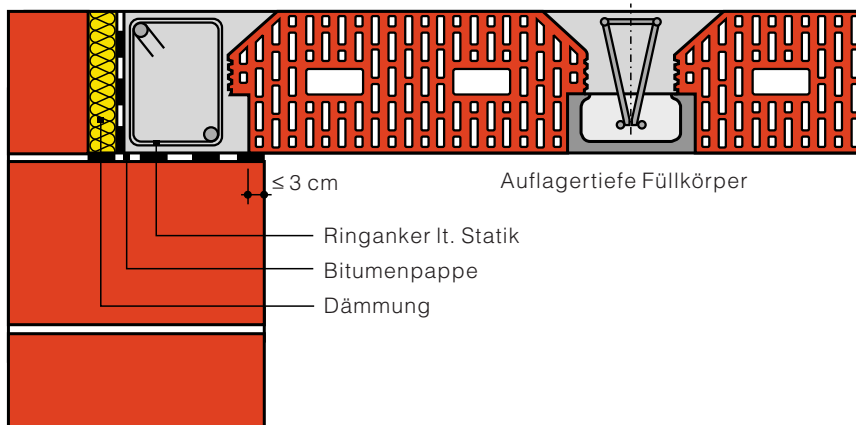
Deckenaufleger einer Stahlbetonrippendecke mit Zwischenbauteilen
